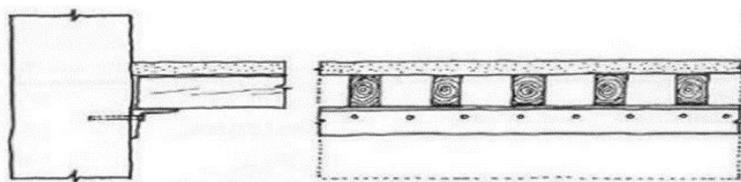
Reforço de apoio através da colocação de cantoneira metálica entre a viga e a parede (Arriaga, 2002)
